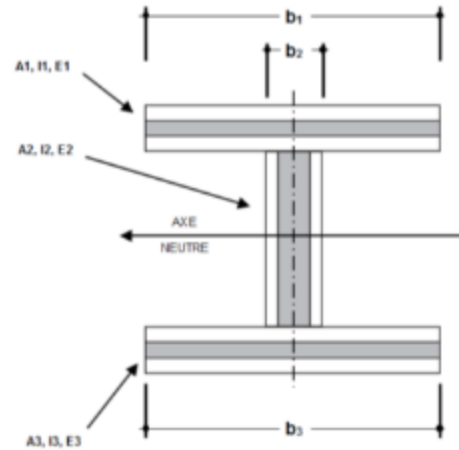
Section partielle d'un caisson NOVATOP ELEMENT
